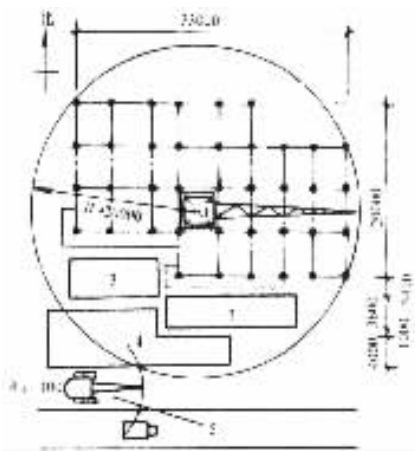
自升式塔式起重机安装框架结构的构件平面布置图
